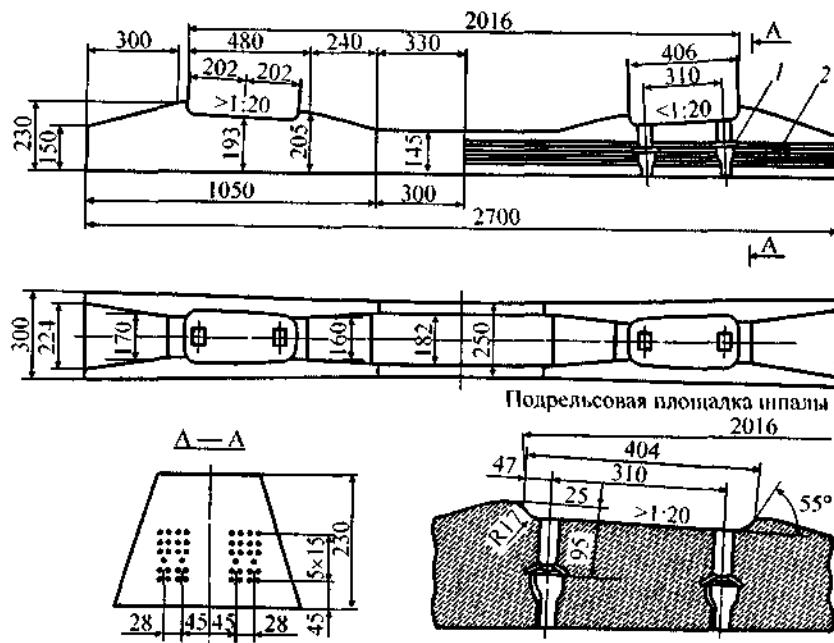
Железобетонная шпала типа Ш1-1: 1 — закладная шайба; 2 — арматура
